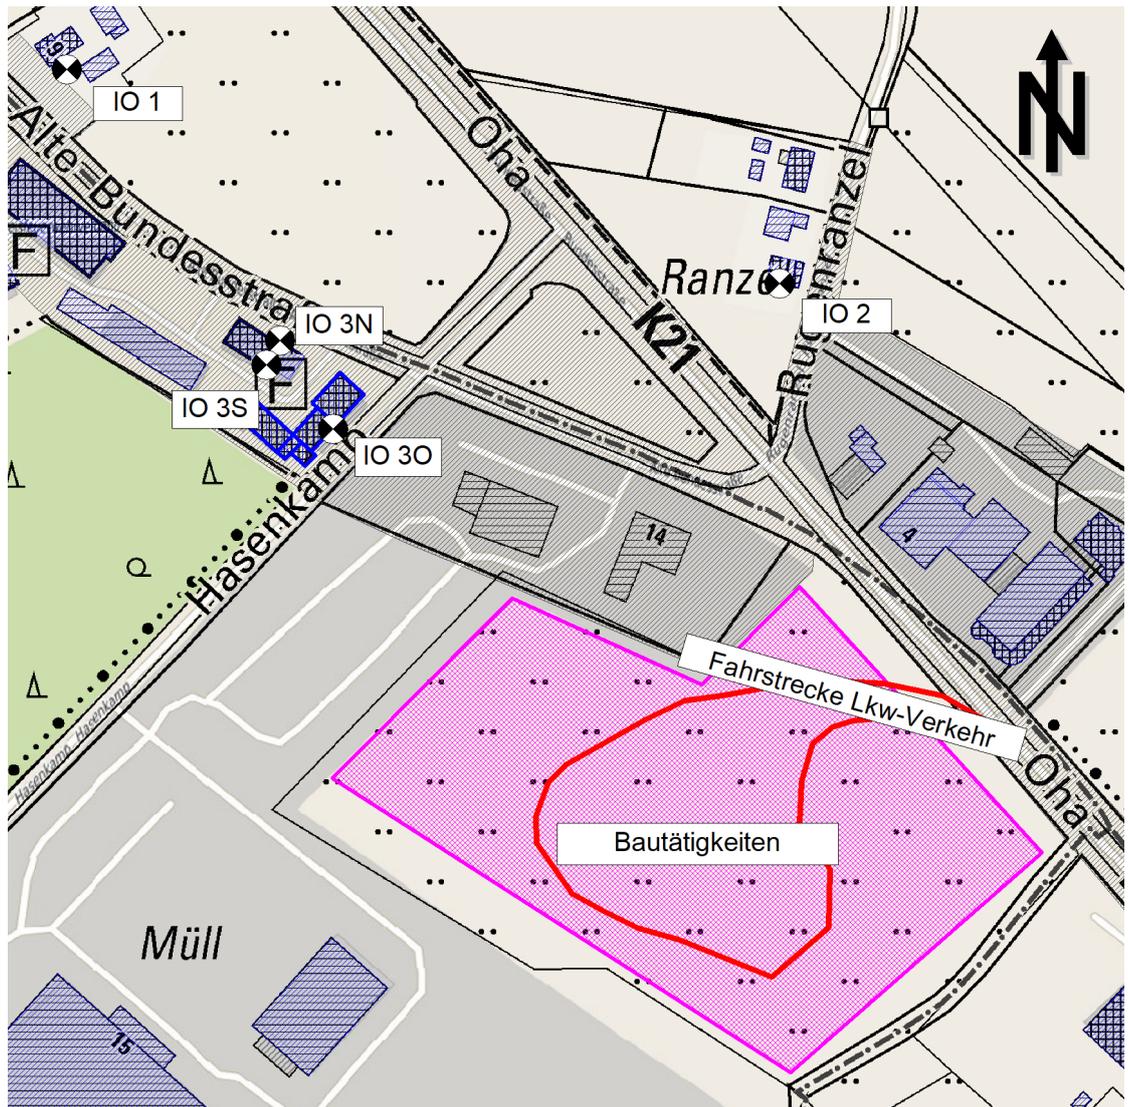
Lageplan Geplantes Baufeld Lastfälle 1 – 4 mit Umgebung und Immissionsorten.
